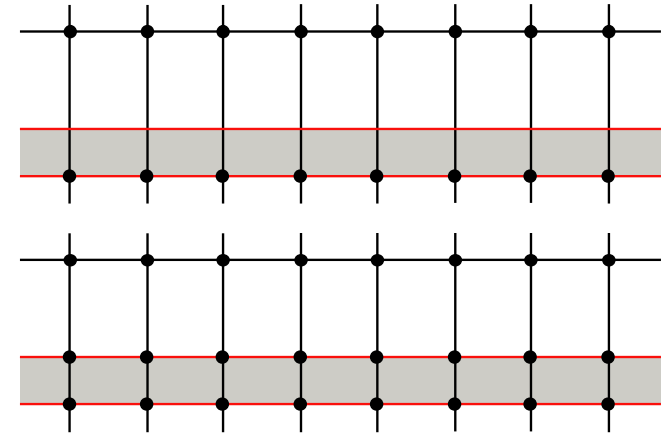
Systemgrundriss, einbündige Anlage mit Flur
